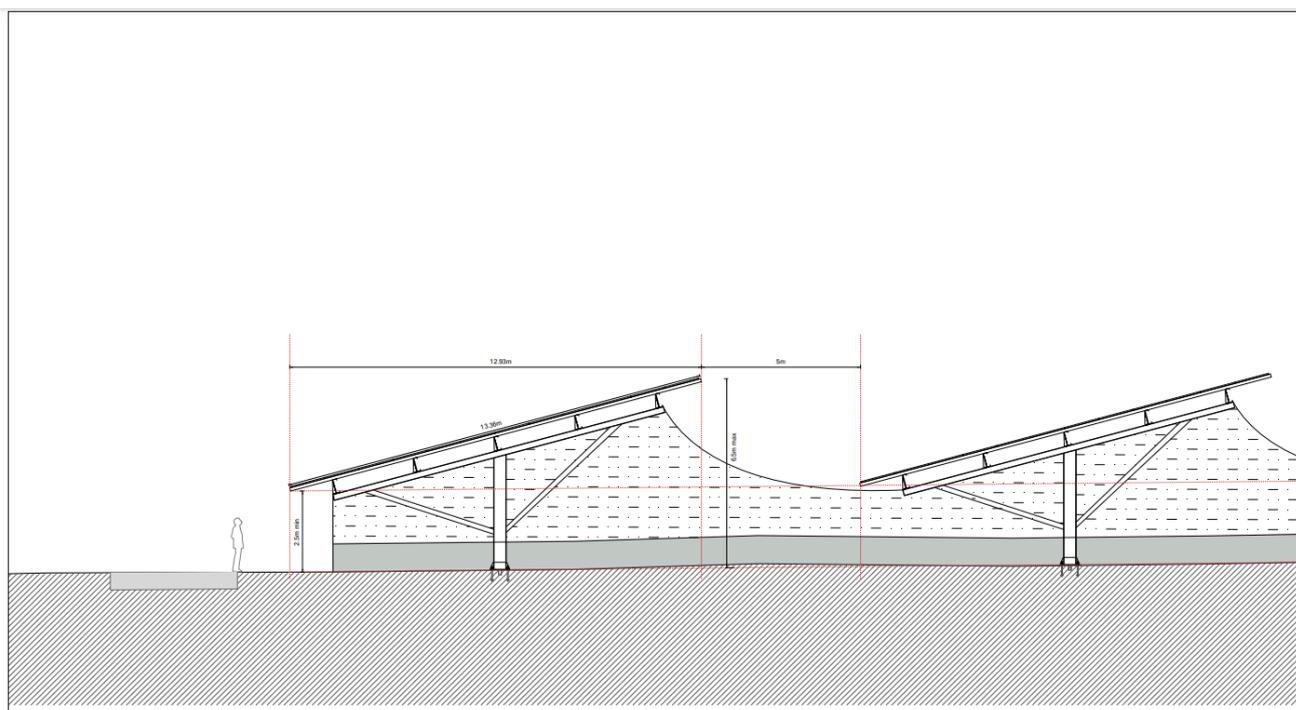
PLAN DE COUPE D'UNE OMBRIERE
